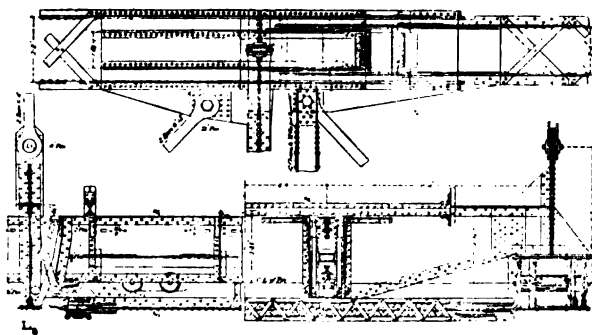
Pont de Memphis : Détails des joints de glissement.
